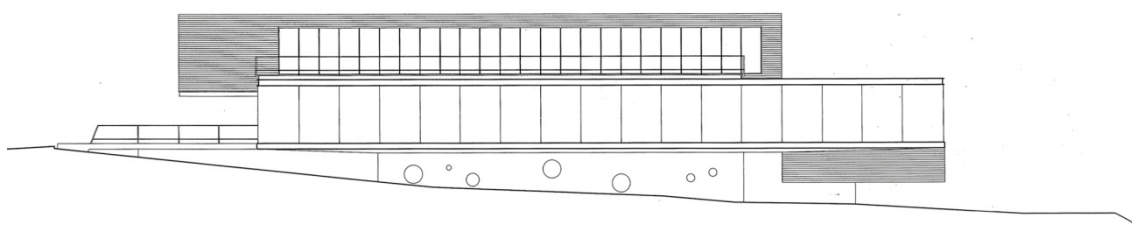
Alzado sur. 2G Revista Internacional de Arquitectura
